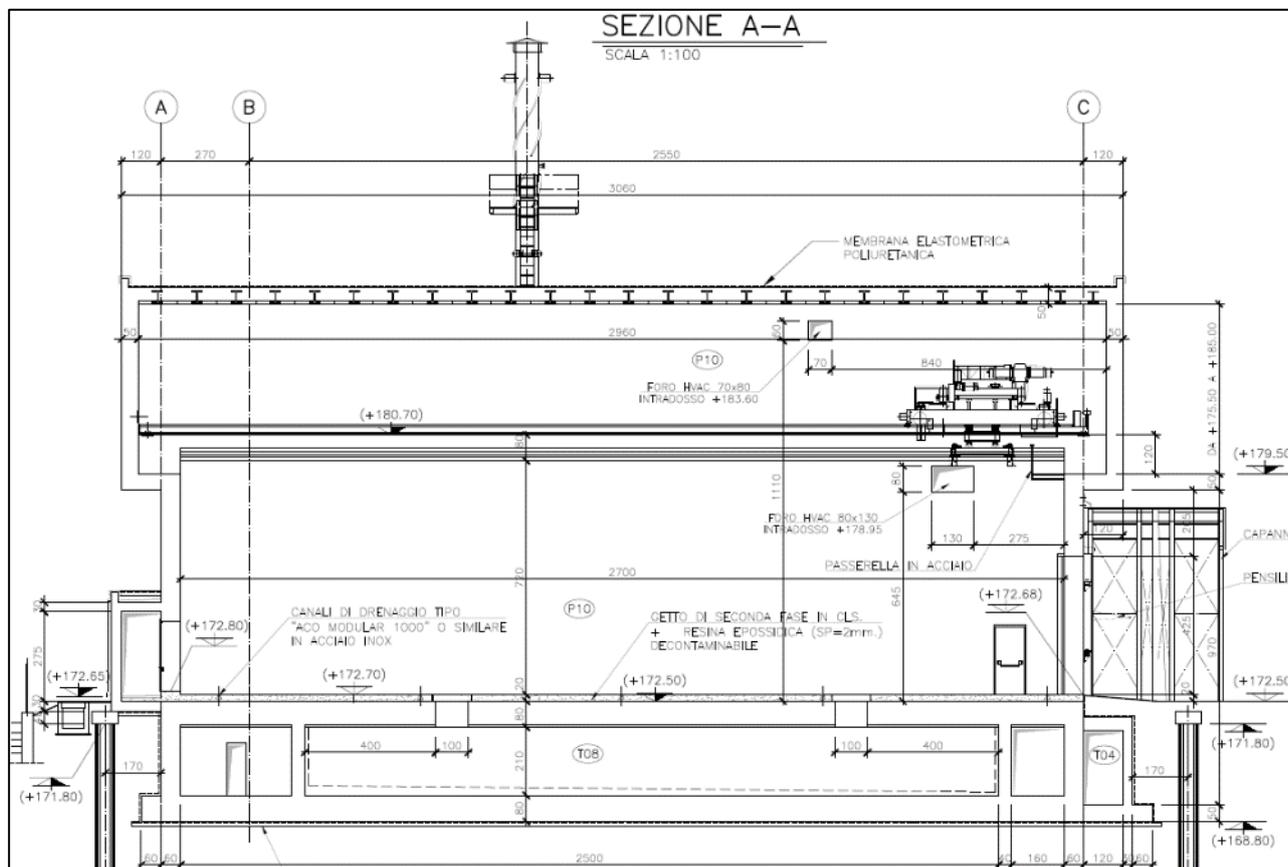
Nuovo deposito 2300 - sezione tipica longitudinale
